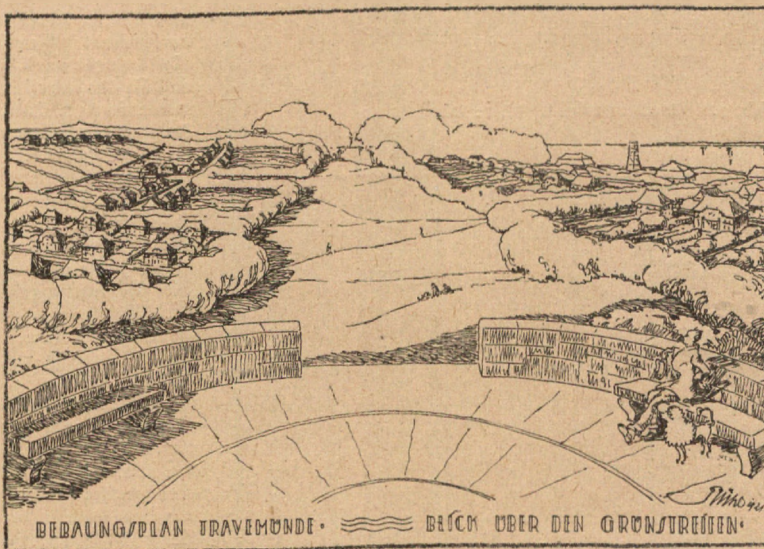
Bebauungsplan für Travemünde. Arch. Reg.- u. Baurat RÜHL, Lübeck.
